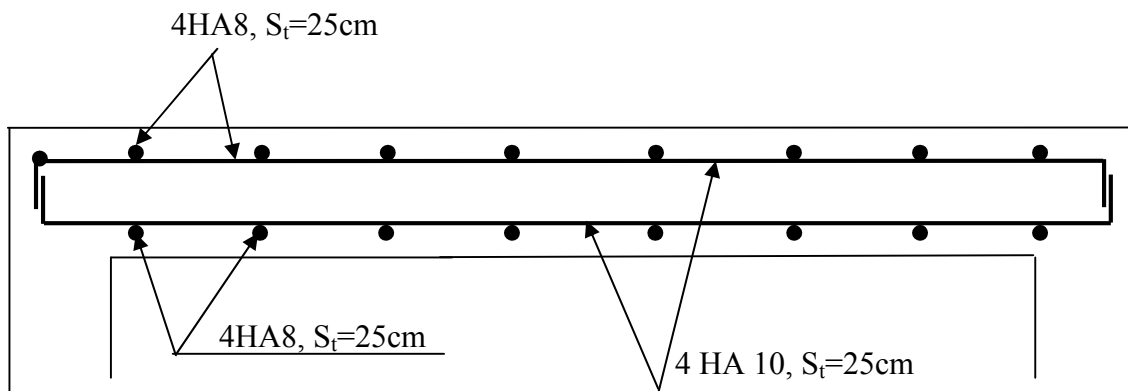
Plan de ferrailage de la salle machine suivant y-y.
